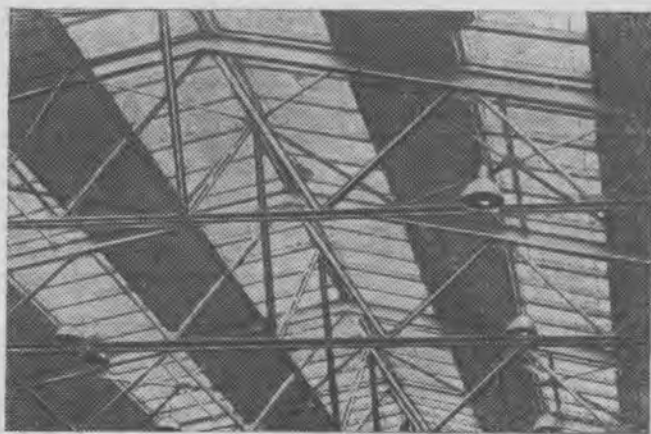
Депо «Октябрь». При реконструкции цеха подъемочного ремонта строители смонтировали над ним зенитные фонари из стекложелезобетона
